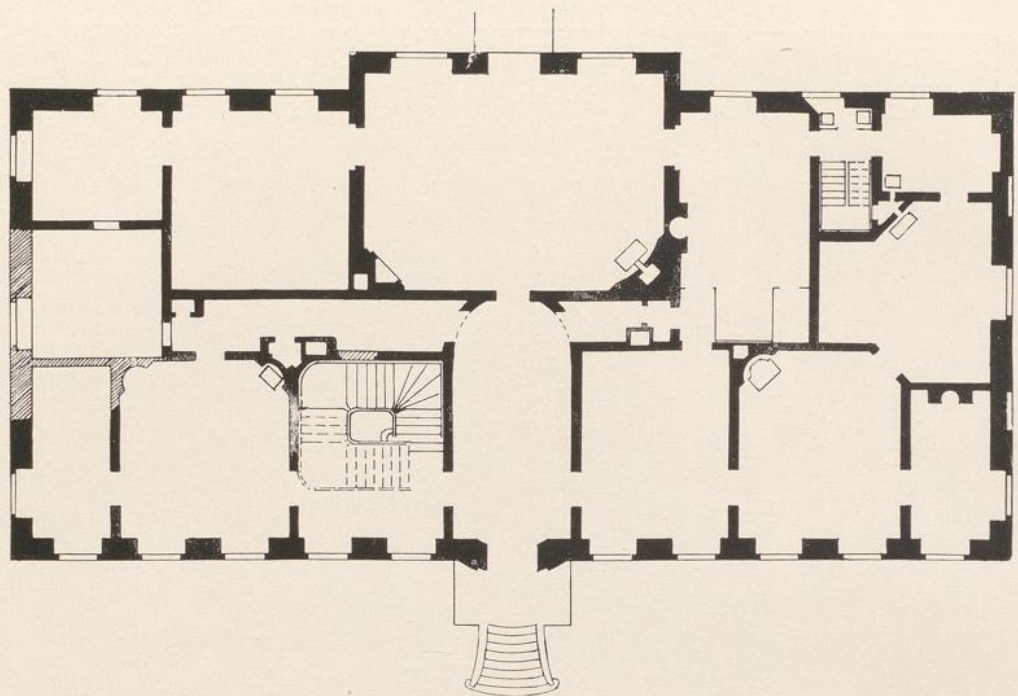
Trebichow. Grundriß. Erdgeschoß
